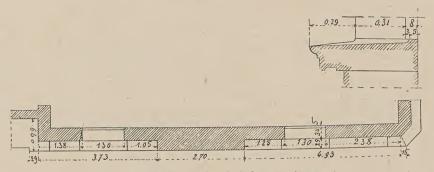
Coupe et plan du balcon en pierre nº 4.
